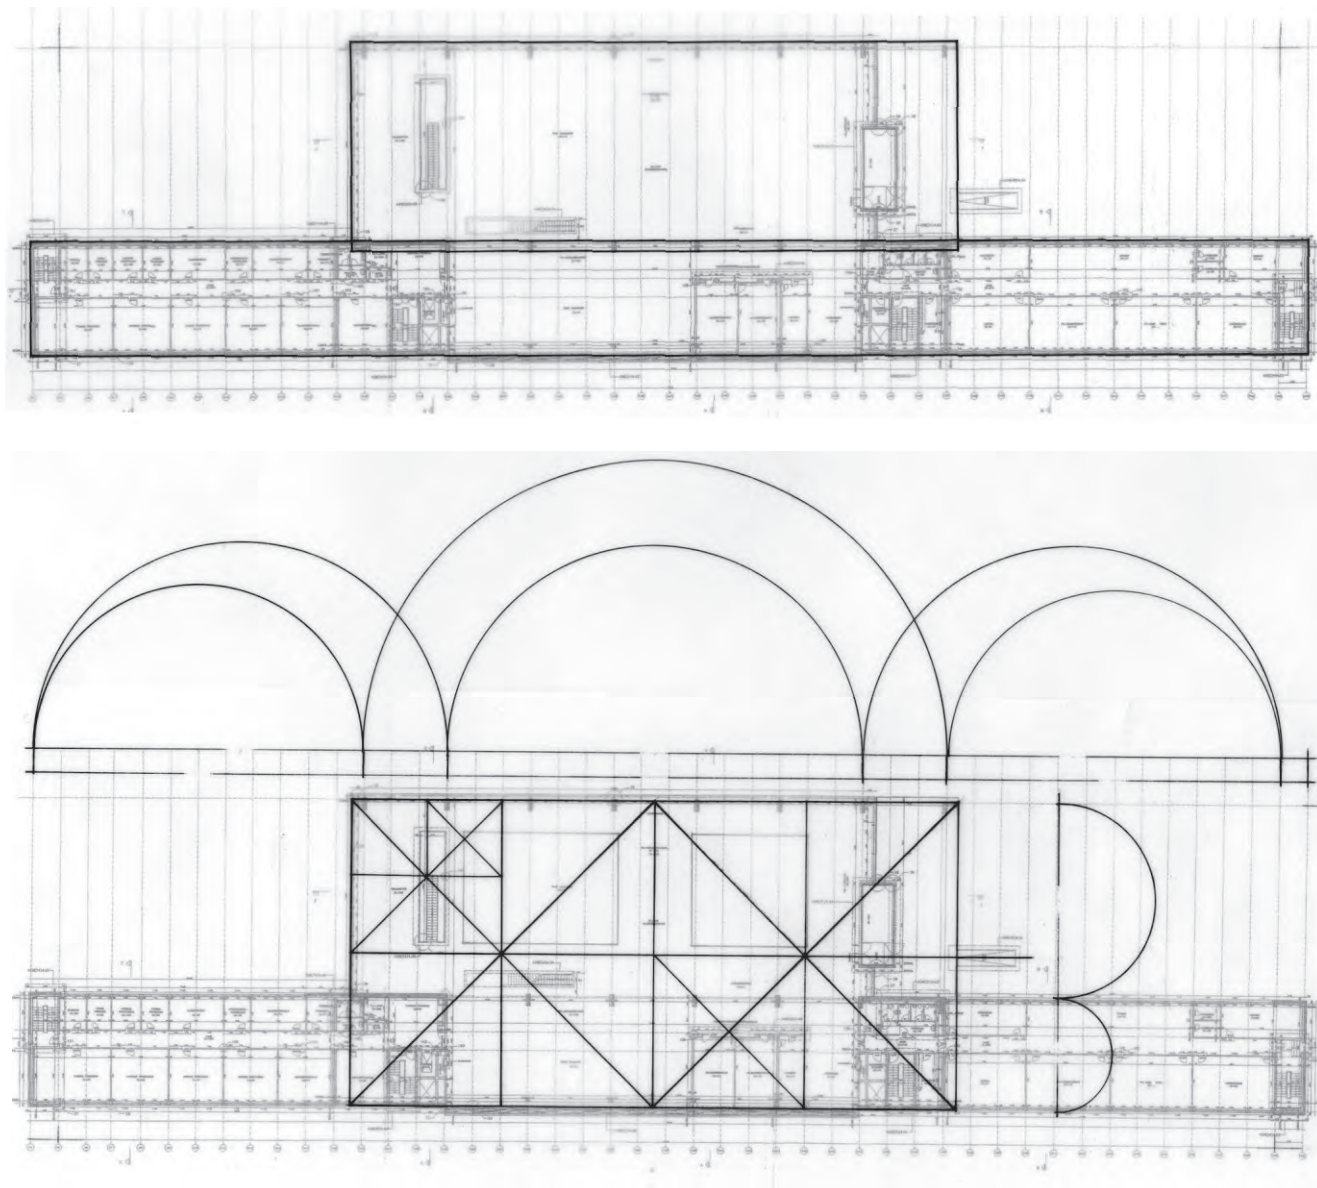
Plan 1:800 af de to primære elementer i bygningen, sal og længe.
